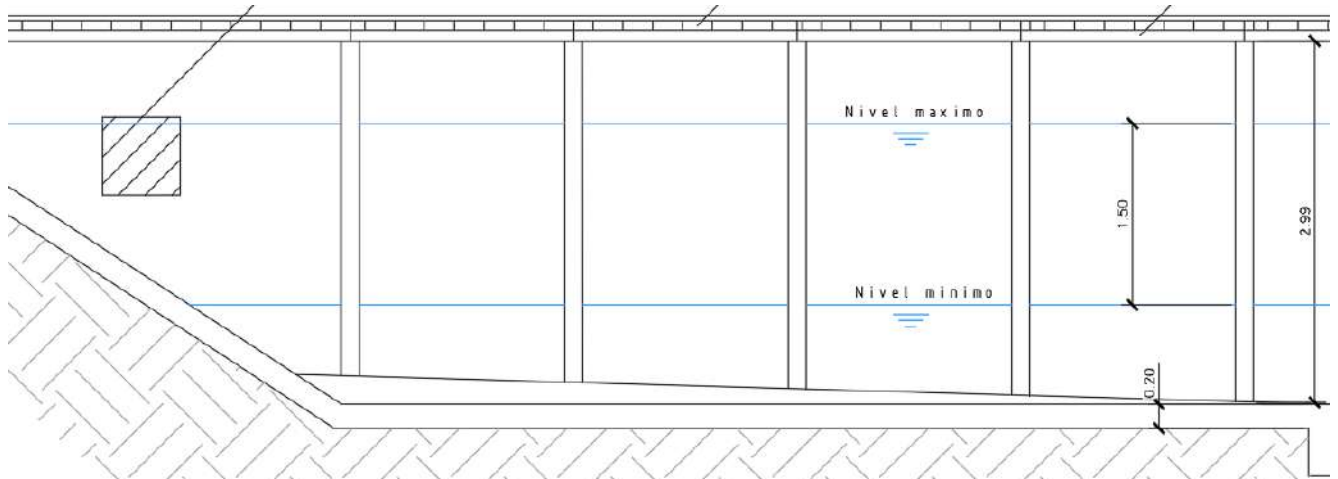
Niveles de la cisterna – Fuente de elaboración propia
